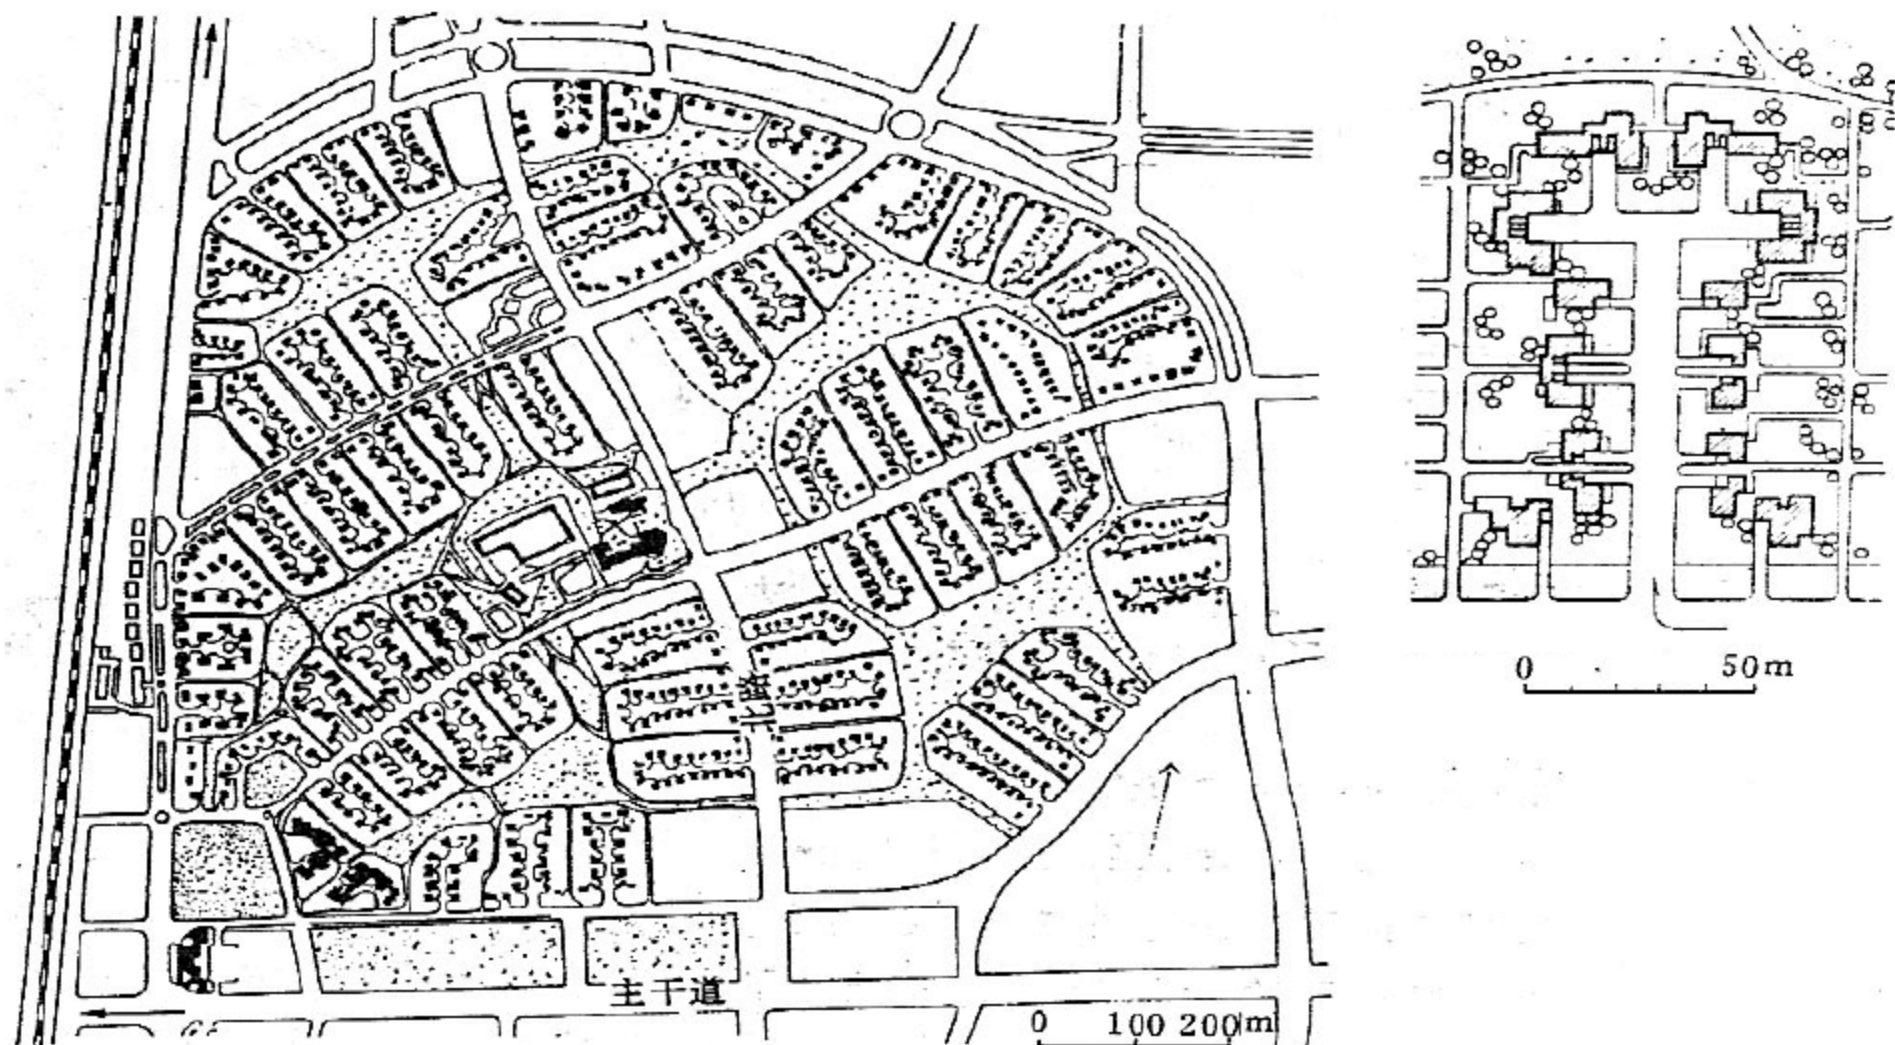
雷德朋(Redburn)总平面图及典型邻里平面图
